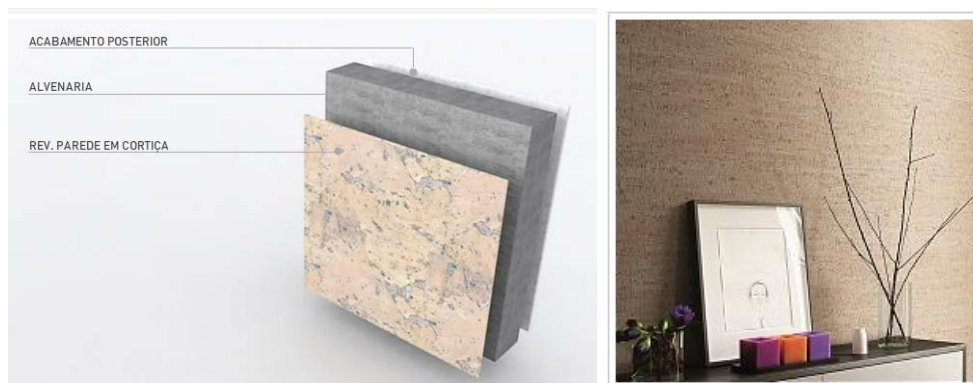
Aplicação do produto Wicanders® DekWall em paredes interiores
